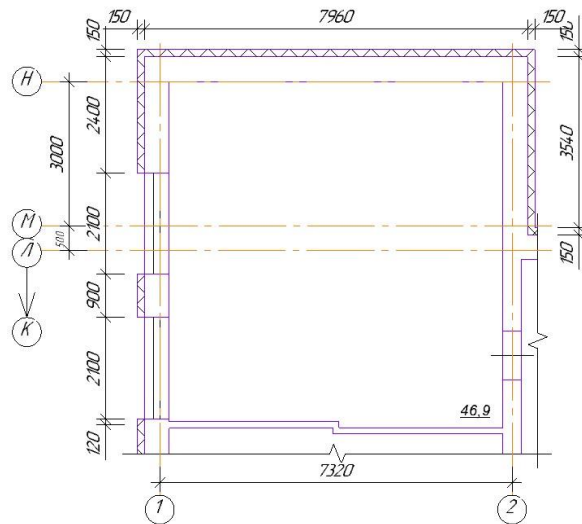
Фрагмент приміщення будівлі для розрахунку теплостійкості
